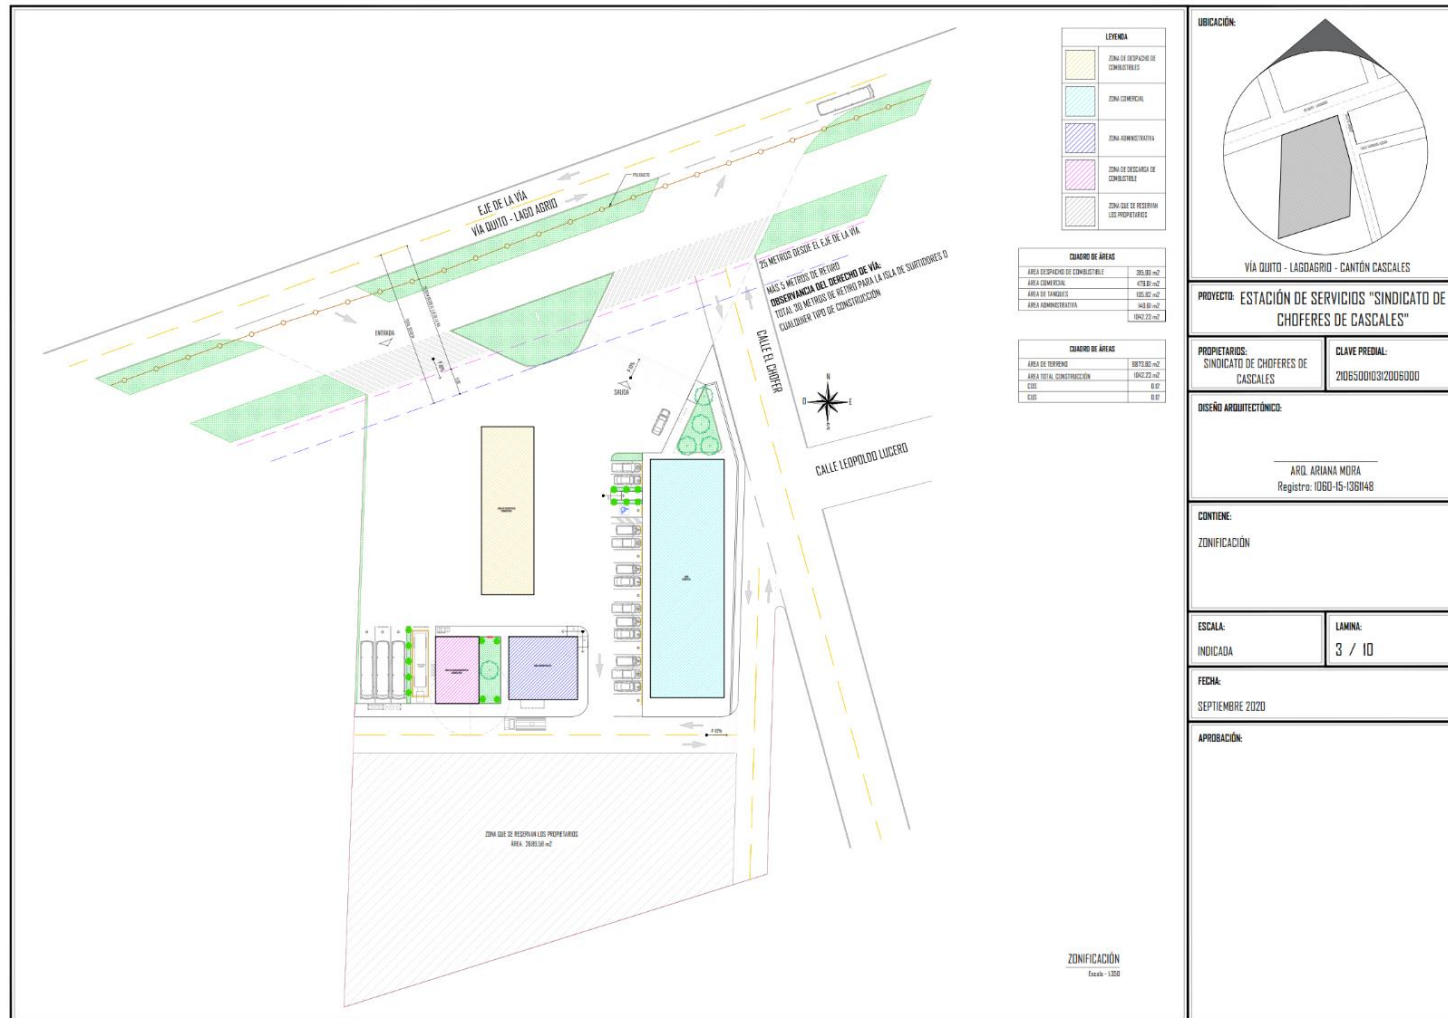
Plano zonificación de áreas. Fuente: Plano arquitectónico
